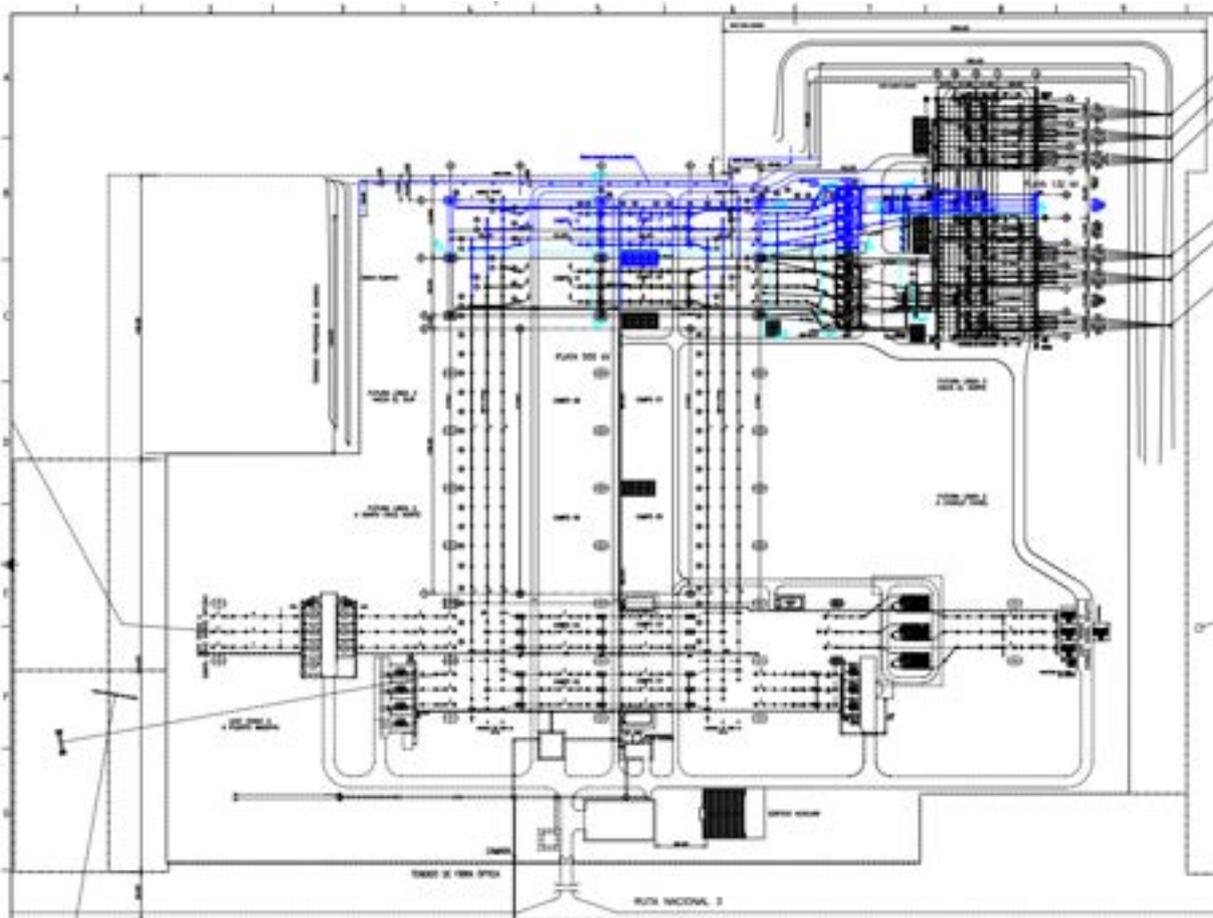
Plano de planta con la ampliación (azul) dentro de la ETPY (negro).
